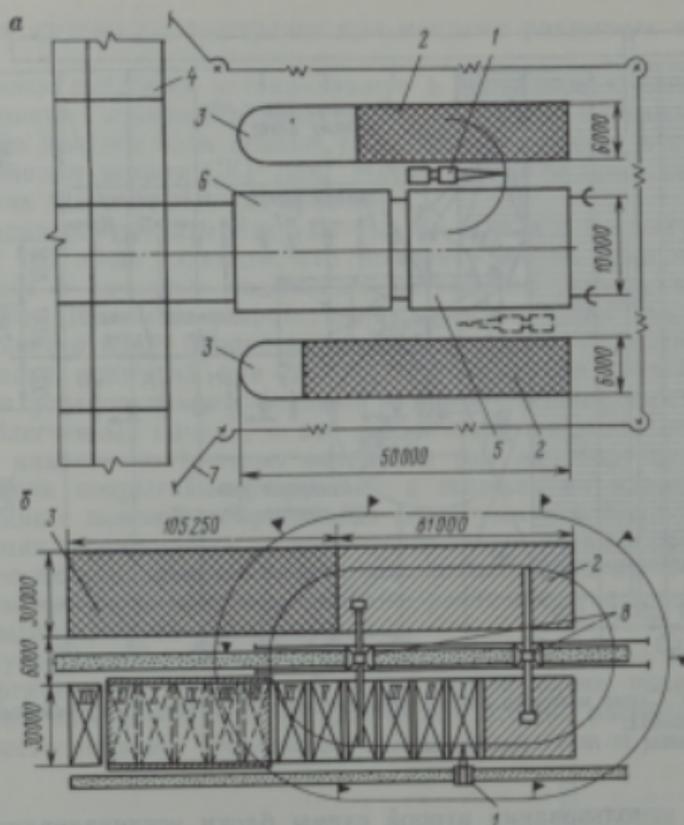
Стройгенплан площадок укрупненной сборки металлоконструкций: 1 — автокран; 2 — склад металлоконструкций; 3 — склад стройматериалов; 4 — объект монтажа; 5 — стенд для укрупнительной сборки блоков; 6 — площадка для установки профилированного настила; 7 — ограждения; 8 — кран-подъемник КП-300, I—XII — стойки конвейера
